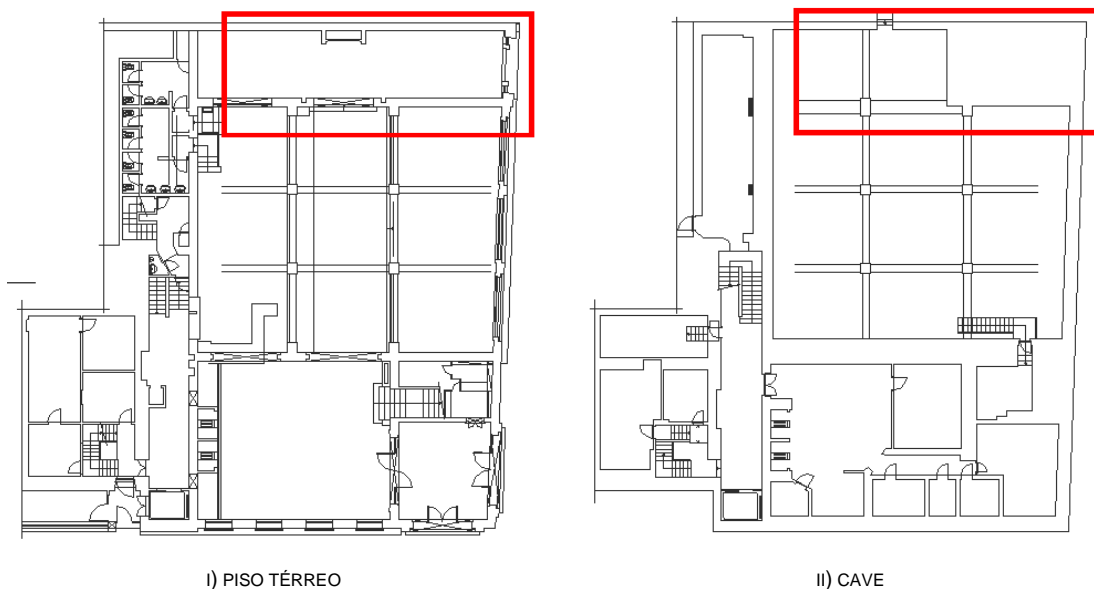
PLANTAS DE ARQUITECTURA DA ACTUAL CERVEJARIA PORTUGÁLIA, ADAPTADO DE [46].
